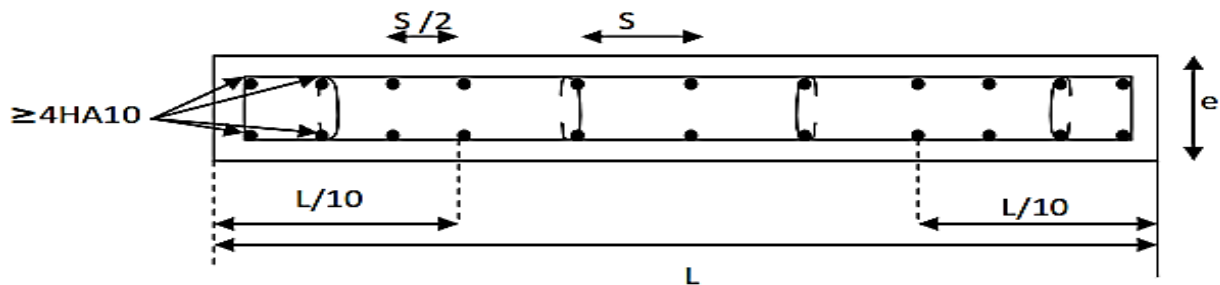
Disposition des armatures verticales dans les voiles.
